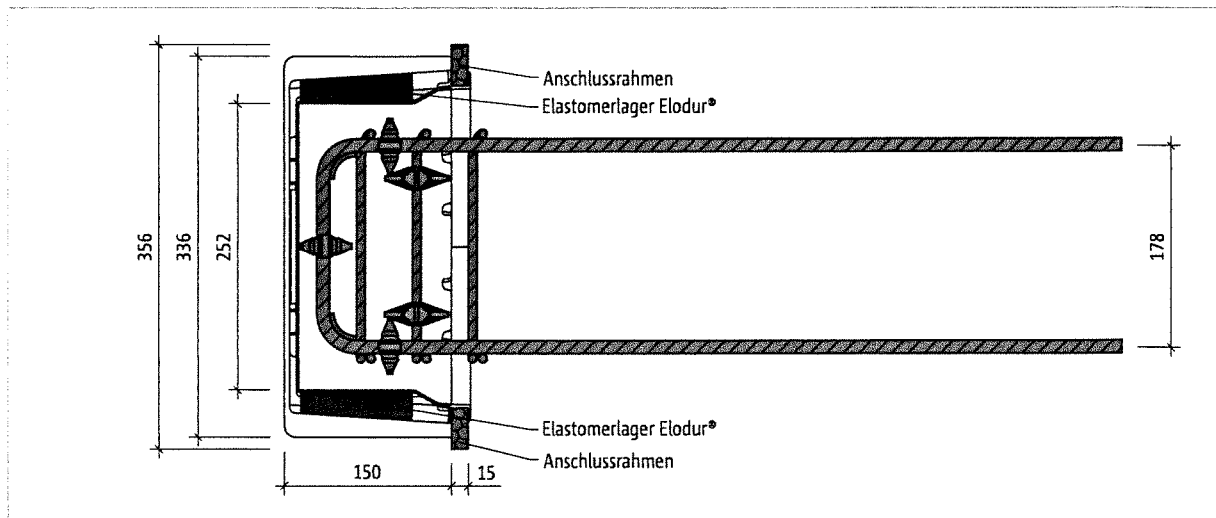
Schöck Tronsole® Typ Z-VH+VH-T: Horizontalschnitt
